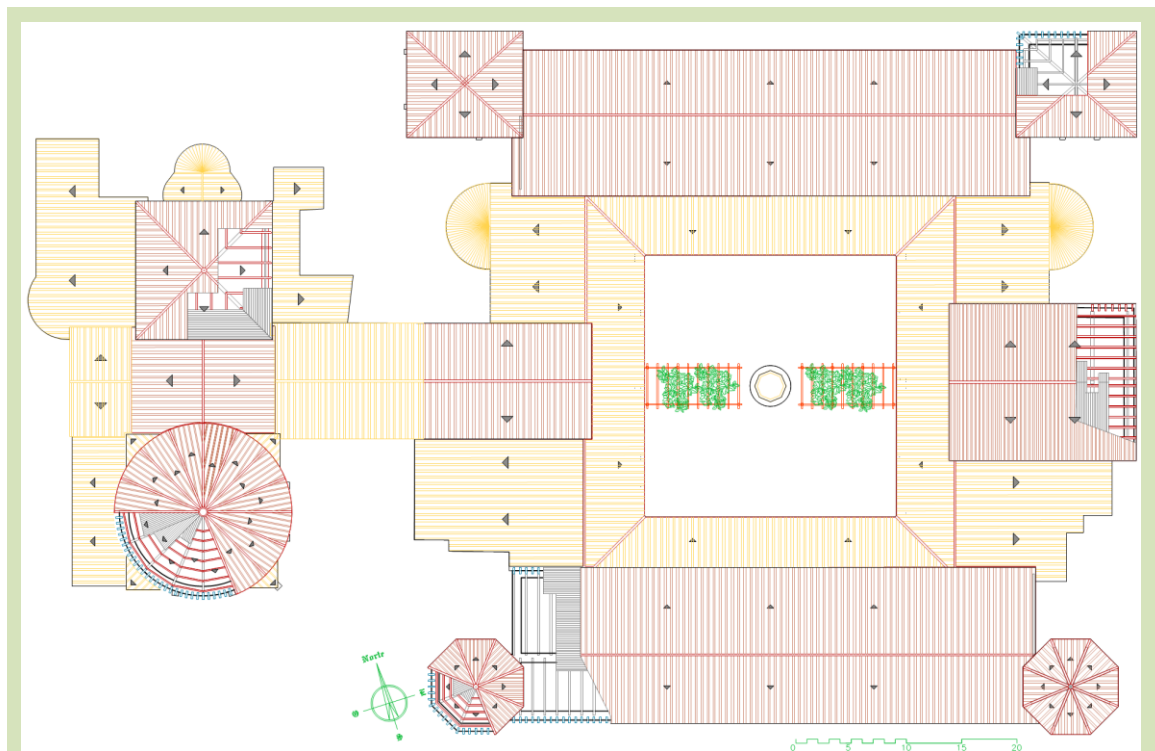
Planta de cubierta general de La Olmeda con ubicación de los detalles que estudiamos en las siguientes figuras. Reconstrucción ideal. CGS.
